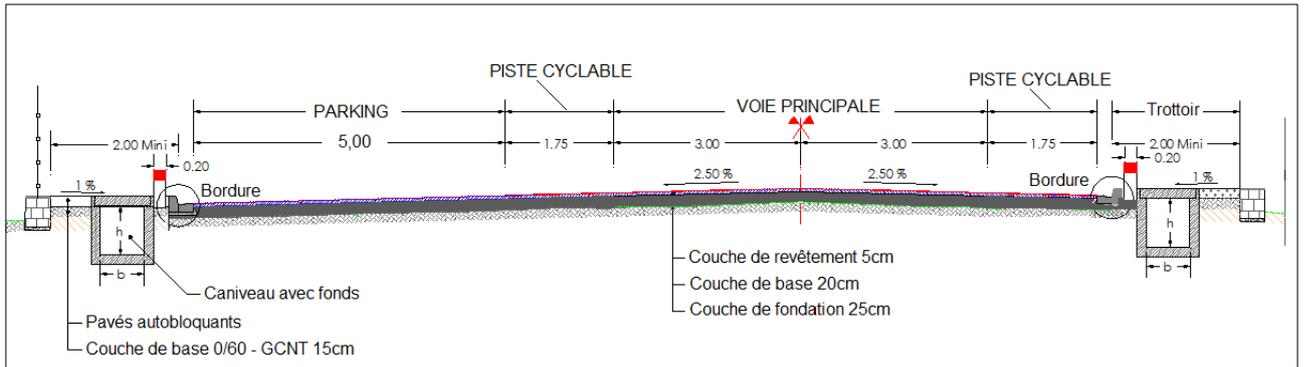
CHUSSEE AVEC 2 PISTES CYCLABLES ET 1 UNE VOIE DE PARKING
